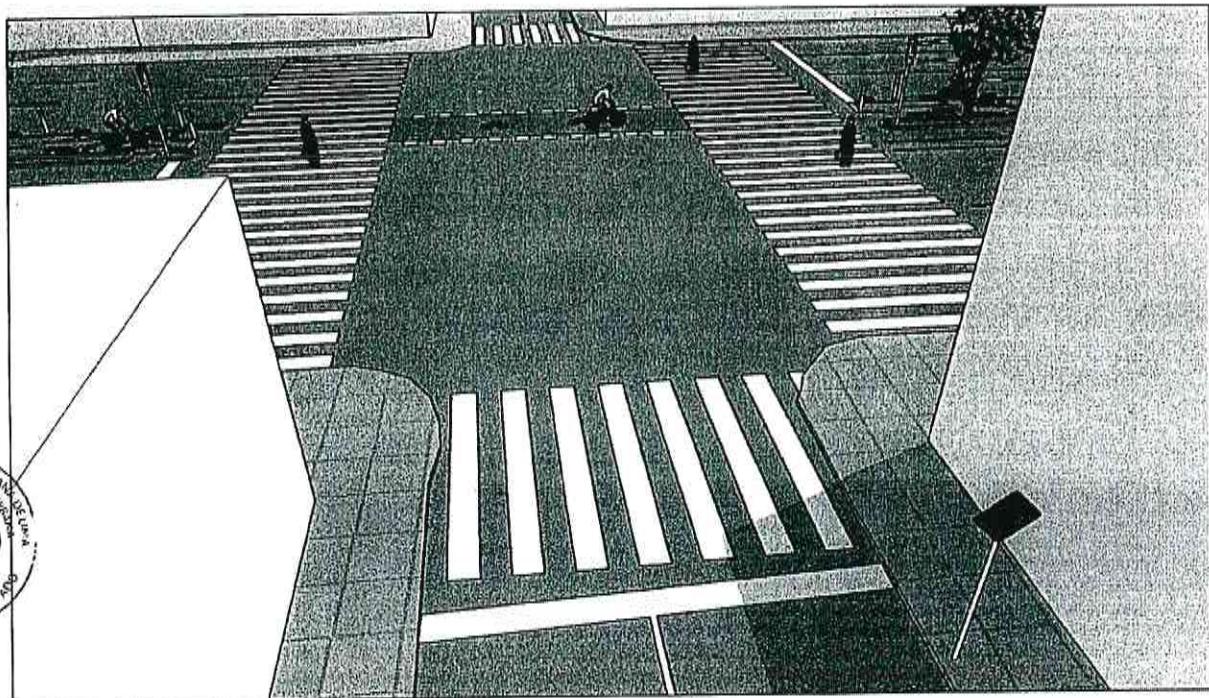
Vista de la propuesta en cruces de calles o avenidas
